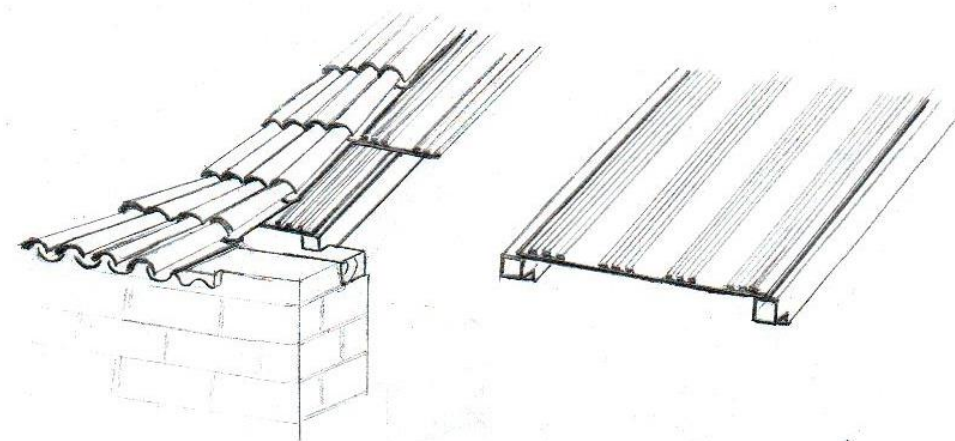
Reforço do telhado com aplicação do sistema de subtelha em conjunto com telha canudo com revestimento, (Fonte: de autor)
